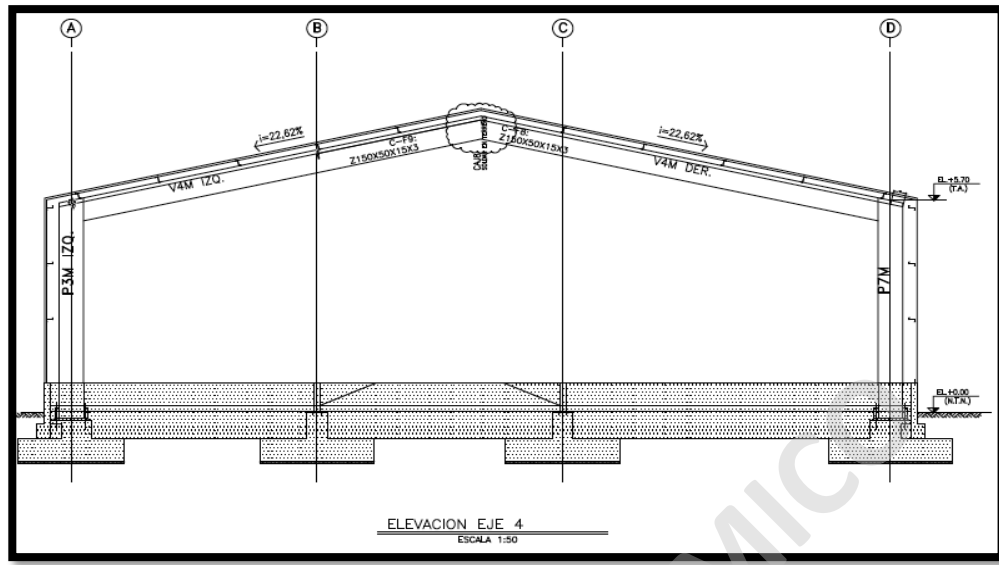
Planos de Montaje ODR Ingeniería y Montajes
